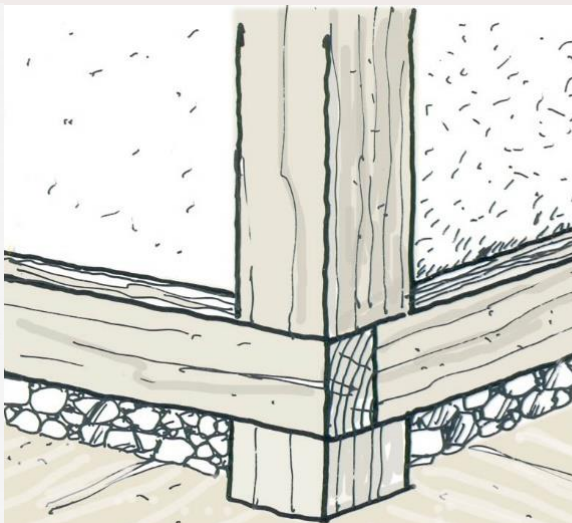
Piedras llenando el espacio entre la pieza de madera y el suelo
